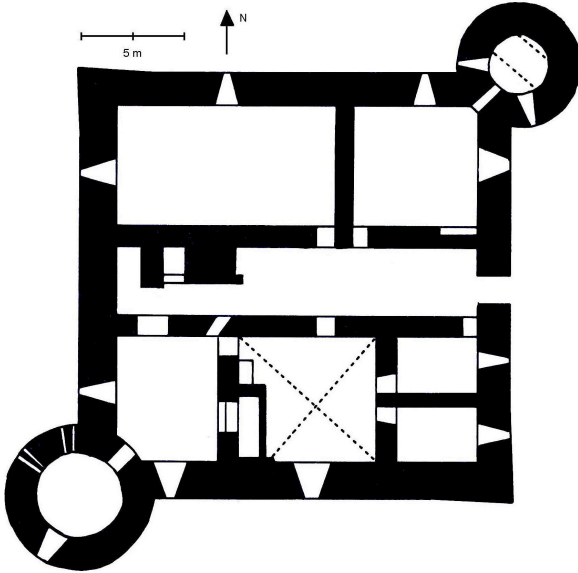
Plan au sol du rez-de-chaussée (vers 1400).
